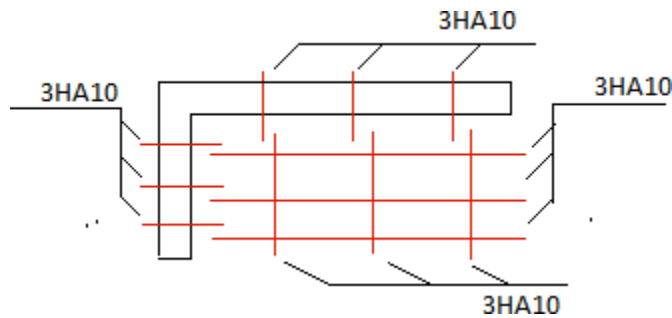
Schéma de ferrailage de la dalle pleine à deux appuis.
